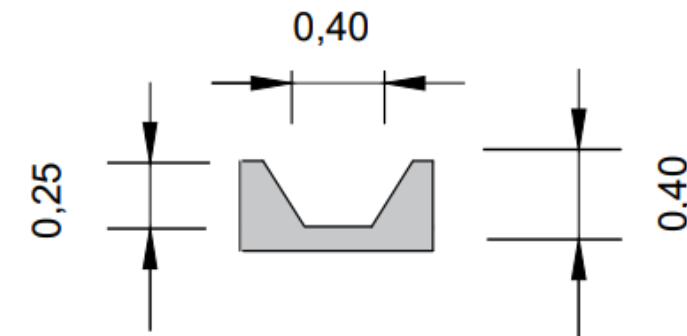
Sección cuneta de coronación. Fuente: Elaboración propia.
